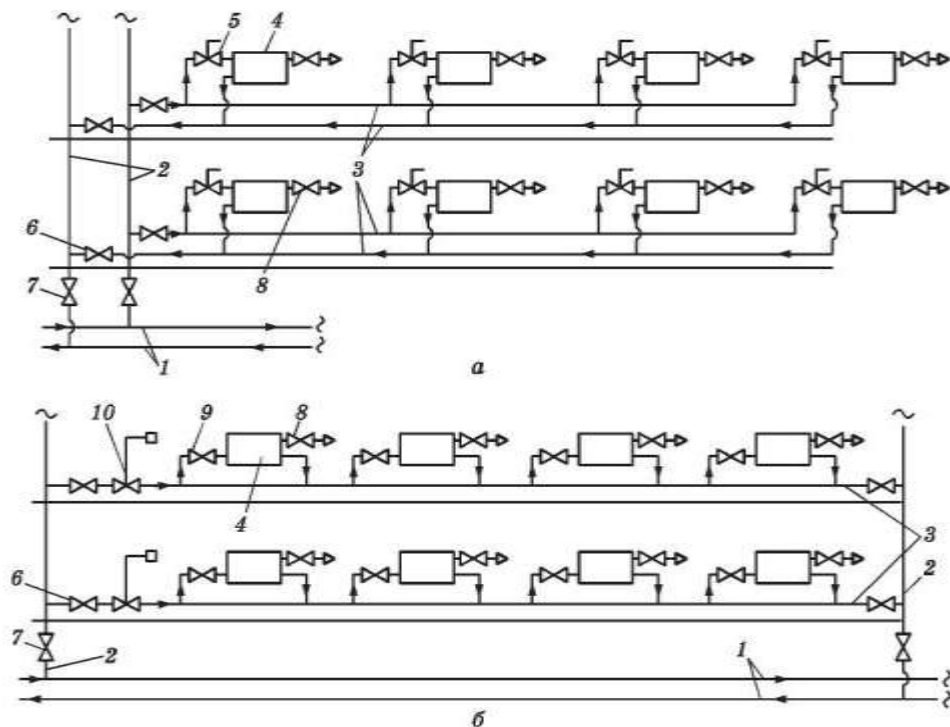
Схемы фрагментов систем отопления с вертикальной разводкой, двухтрубными (а) и однотрубными (б) горизонтальными ветвями:
